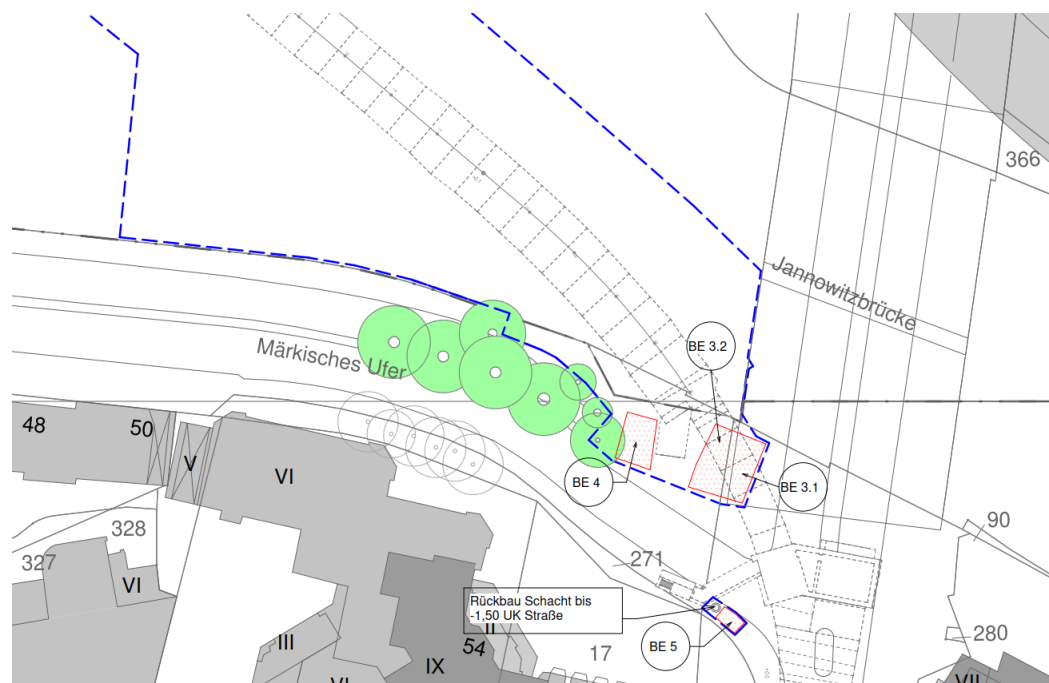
Lageplan mögliche temporäre Baustelleneinrichtung Märkisches Ufer
